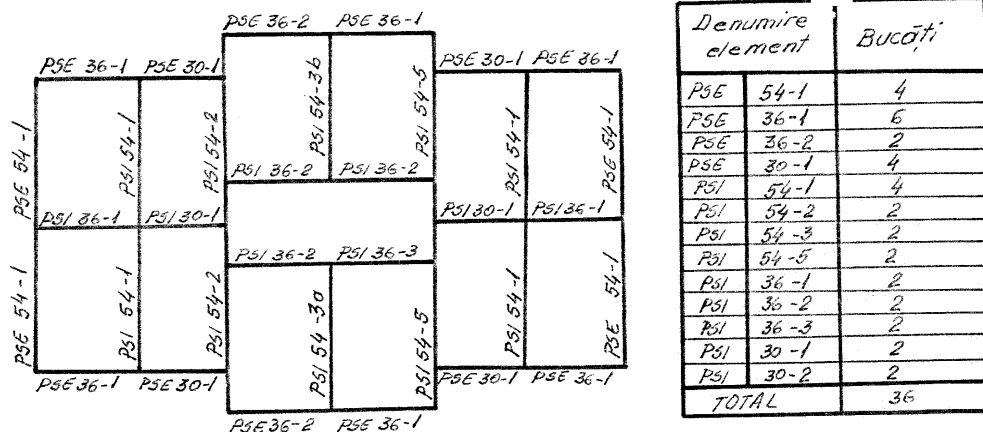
Planul de montaj și simbolul elevațiilor care alcătuiesc infrastructura
